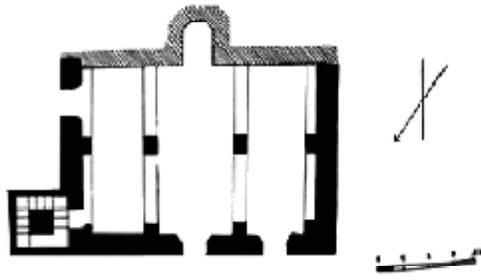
مسقط أفقي للطابق الأول بالمدروسة الشمامعية بتونس، عن: Golvin, L., Ibid., pl 50, p.177.
